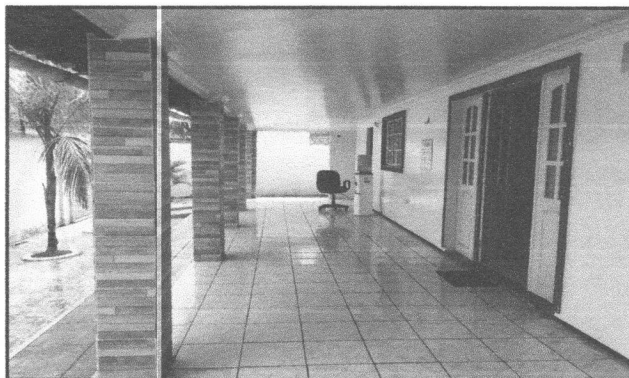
Vista da Varanda, com destaque a esquadria em madeira, piso cerâmico e forro em gesso
